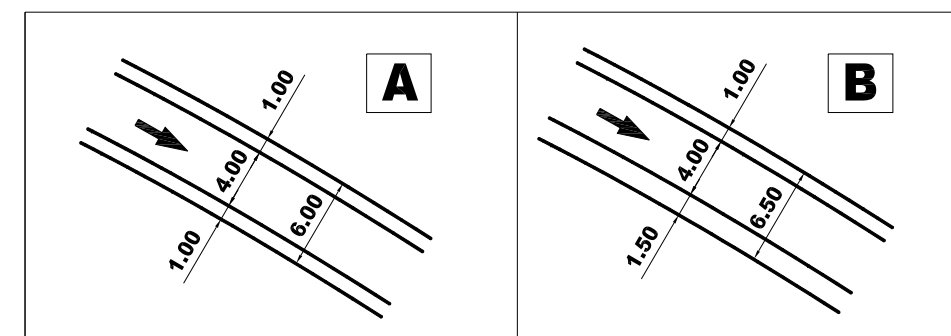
Schema planimetrico adeguamento rampa di svincolo esistente
